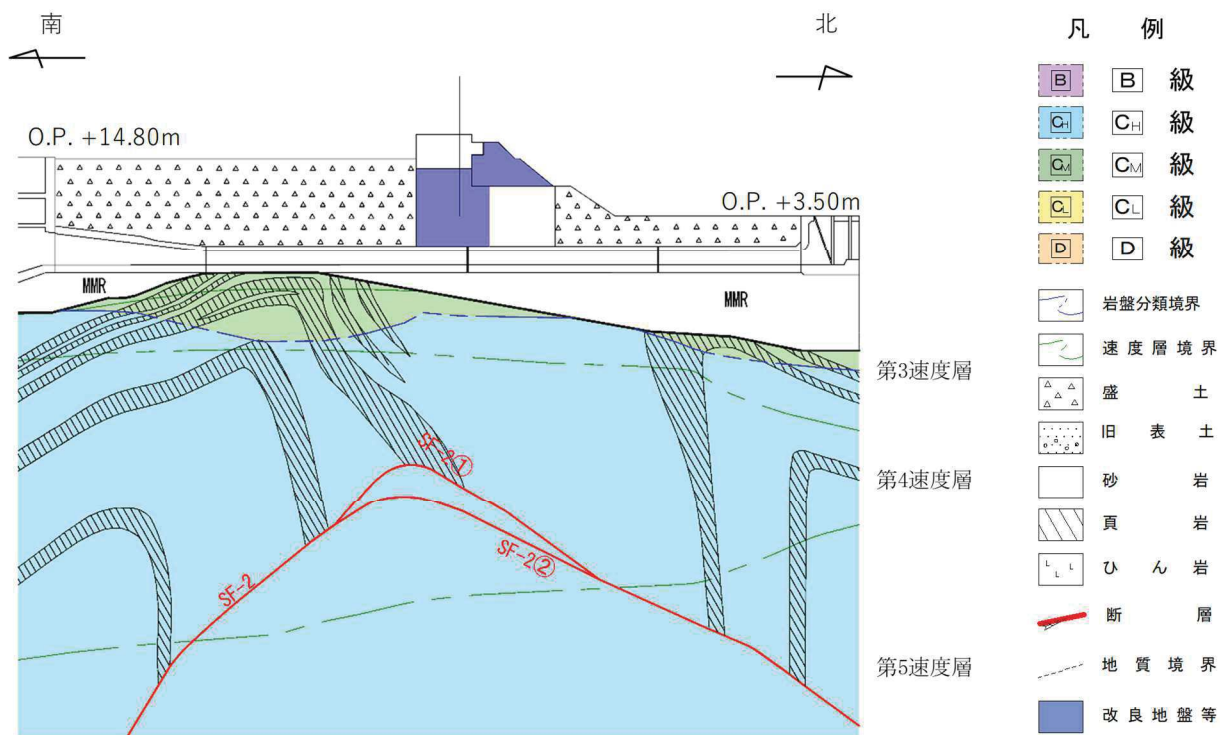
(1) 取水路の地質断面図 (⑲-⑲断面)
